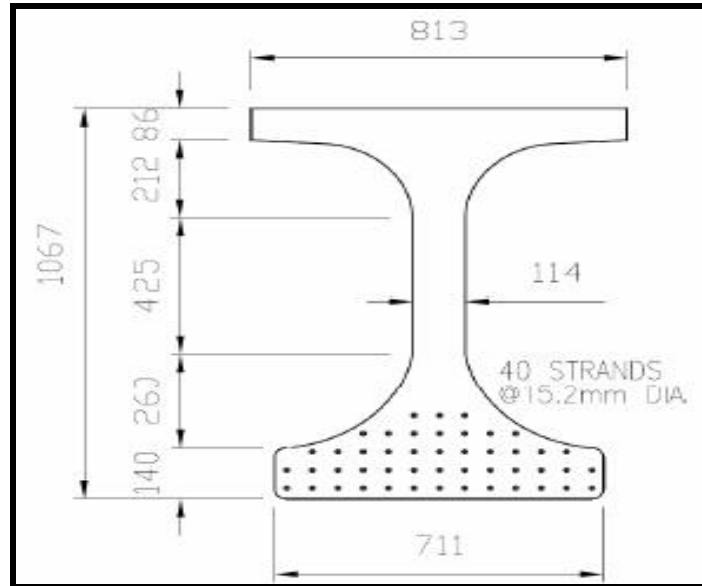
Shepherds ırmağı üzerindeki, RPB kullanılarak yapılan ilk araç köprüsü kirişi [32].
